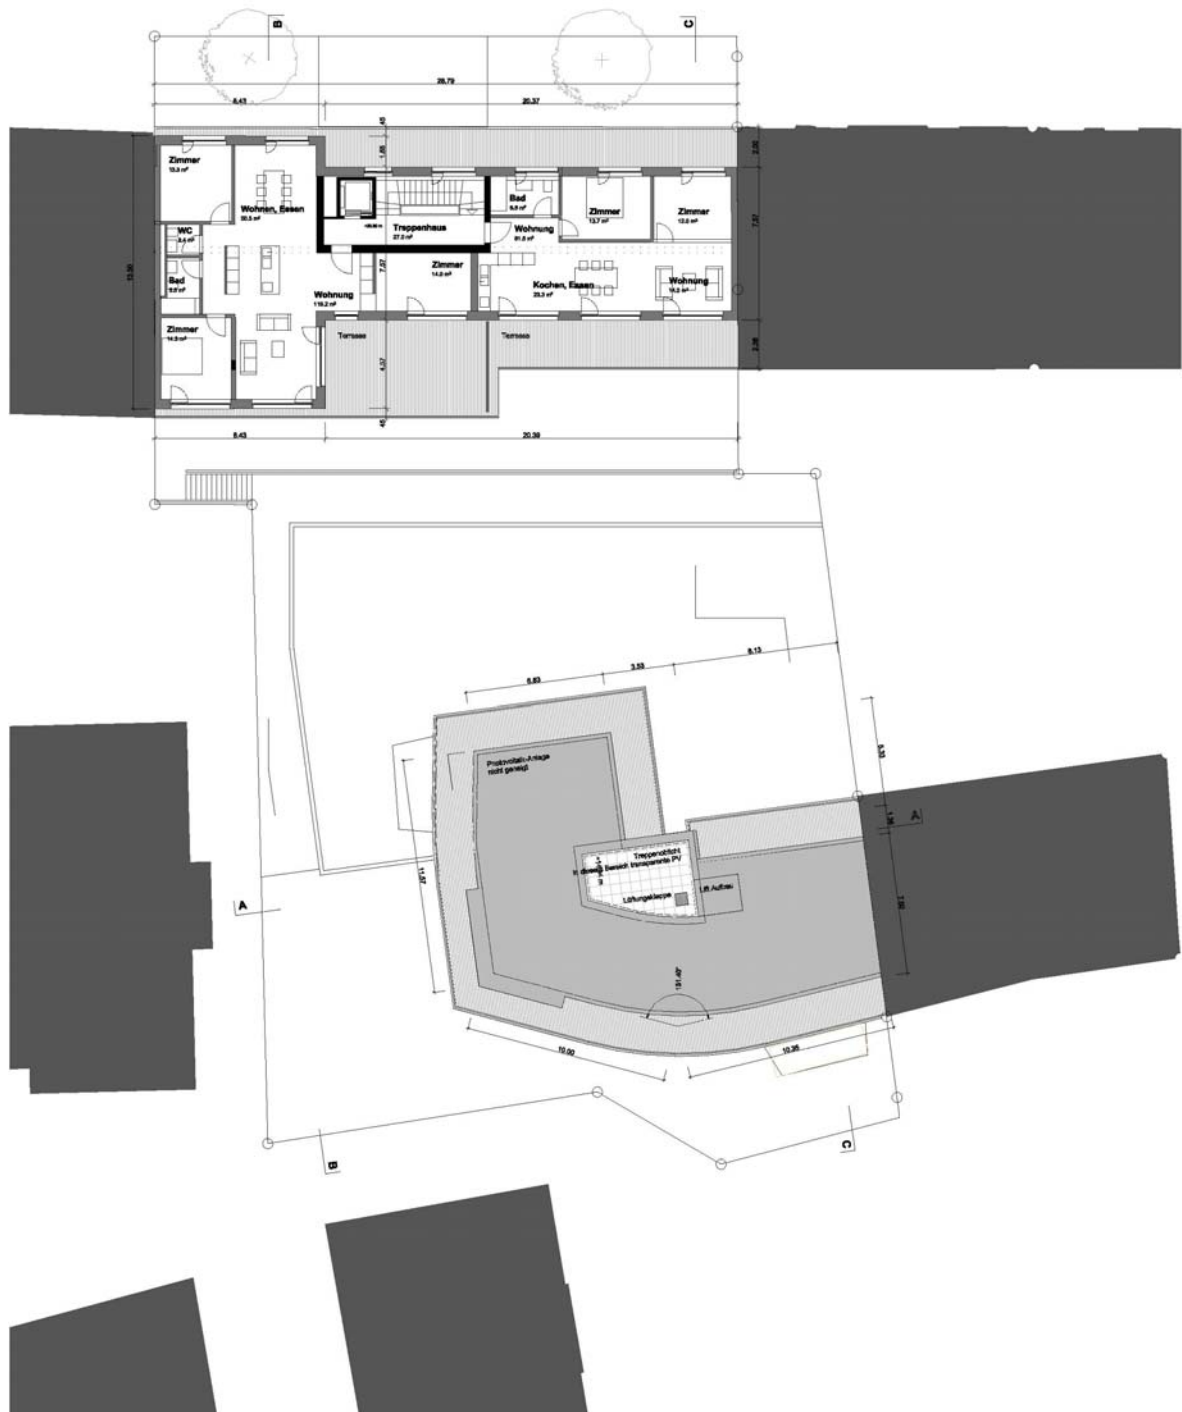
Provisorischer Grundriss DG, Wohn- und Bürogebäude Mühlebachstr. 8 und Hufgasse 11, Zürich
